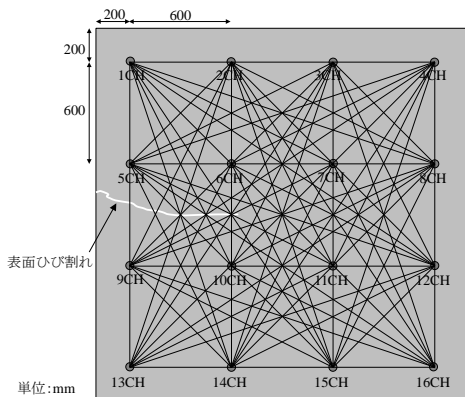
鉄筋コンクリート床版の表面ひび割れ
